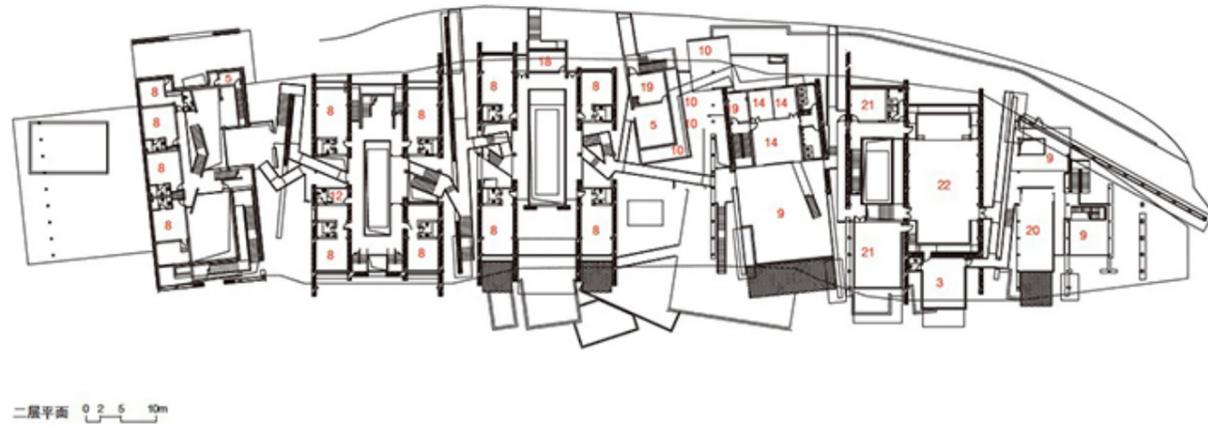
131. Planta primera del proyecto. (Imagen extraída en revista: Journal Architectural 2014 edición 1, página 33).
